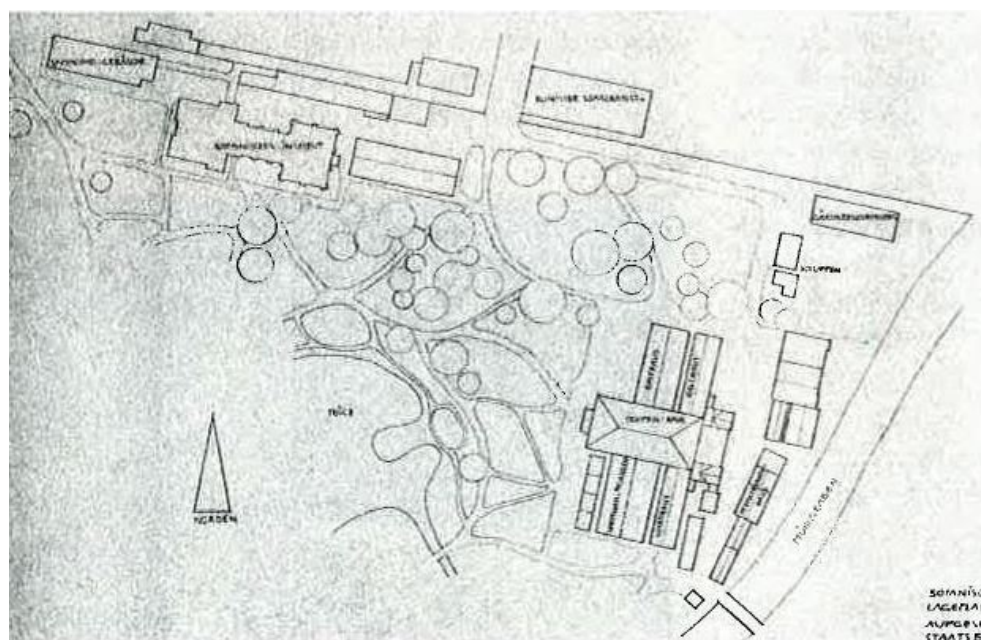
Lageplan vom 12.11.1959, am Ostrand die neuen Gewächshäuser mit der großen Tropenhalle, aus BECKER 1997, S.46
